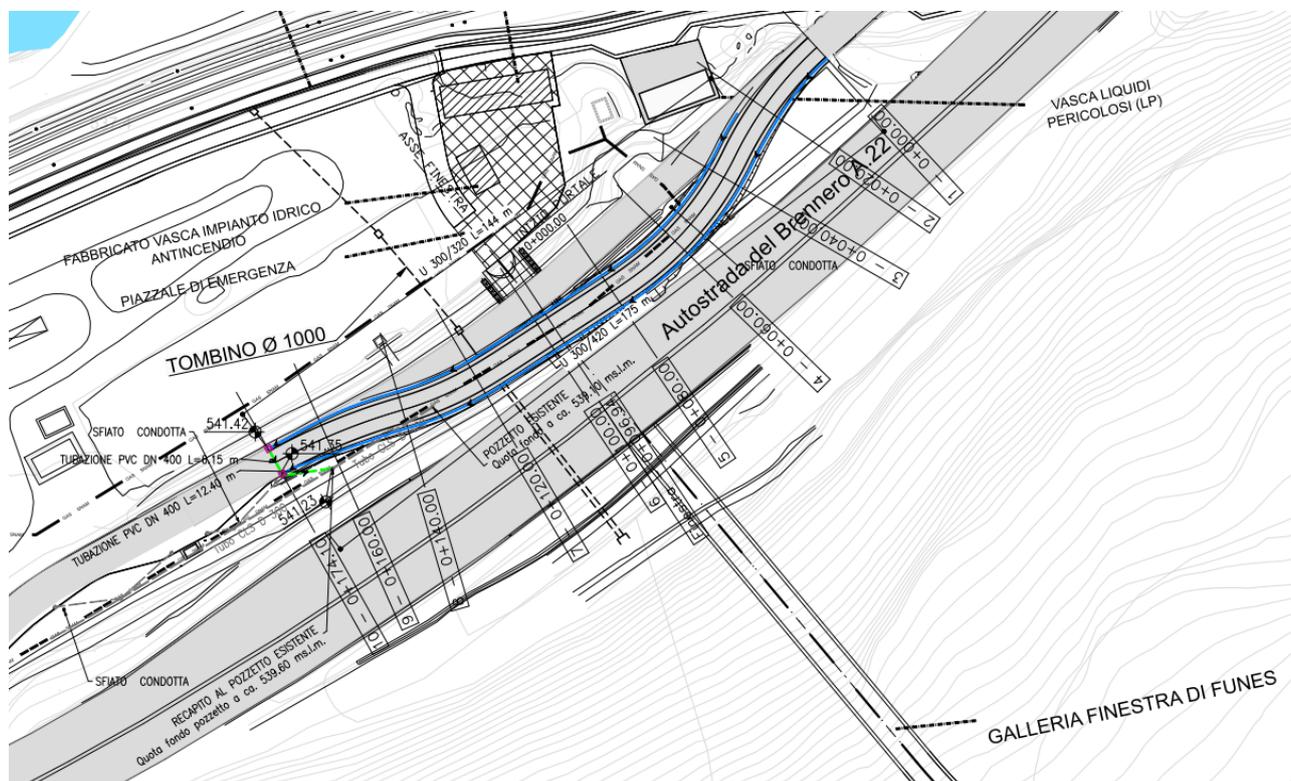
Planimetria idraulica rete acque di piattaforma
